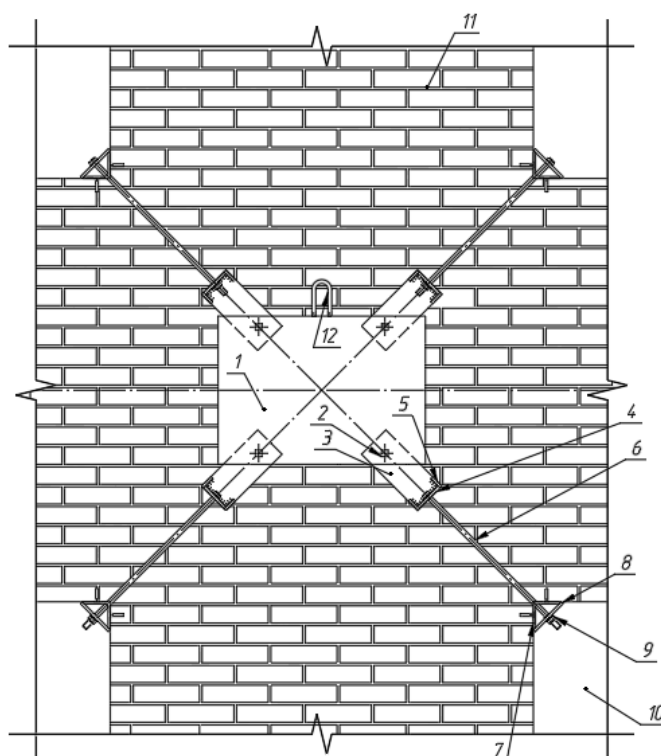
Конструкция для временного усиления кирпичных стен с проемами при демонтированных перекрытиях (изображен разрез II-II на рис. 2):
